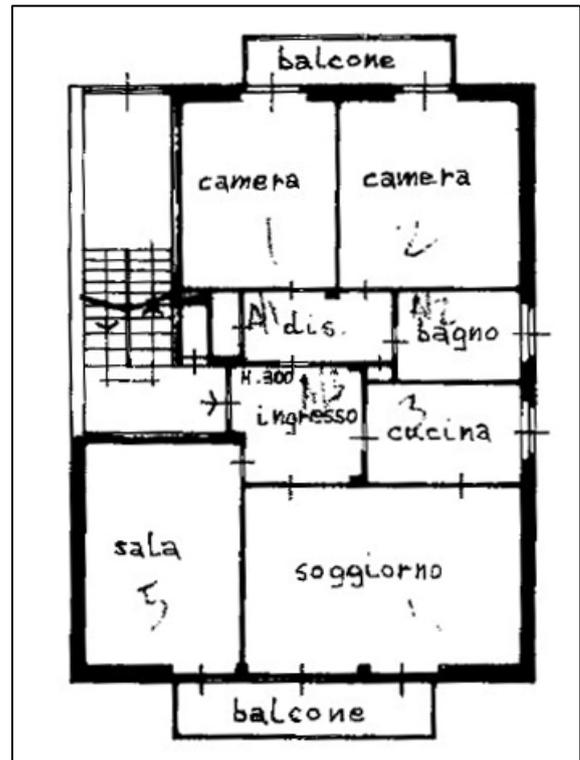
Planimetria catastale del 20.03.1995 - Piano 1°
